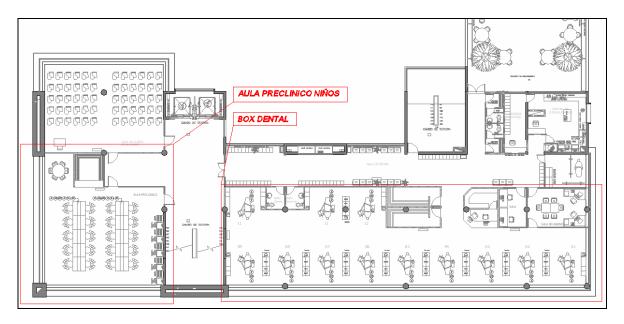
PLANTA ARQUITECTURA SEXTO PISO
